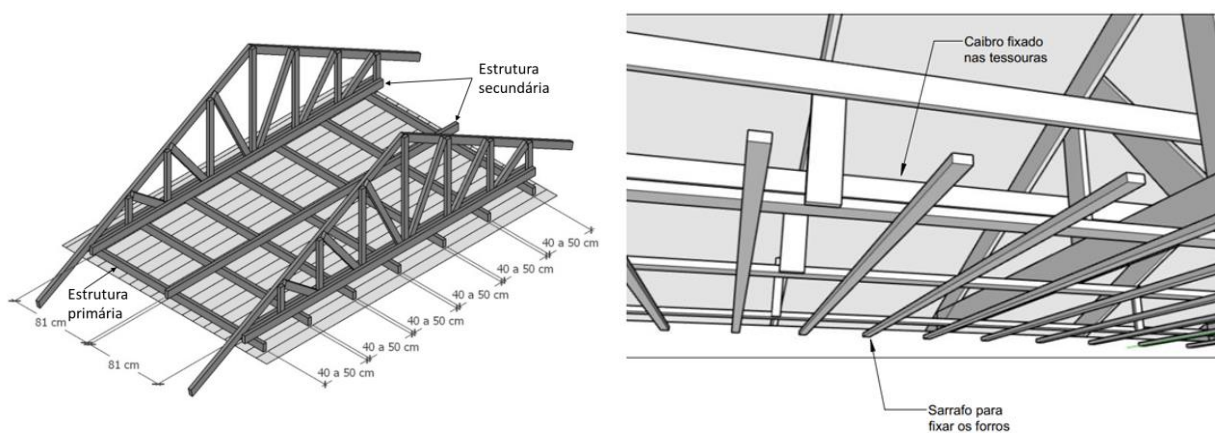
Perspectiva dos elementos constituintes da estrutura de sustentação do forro com perfis de PVC rígido
